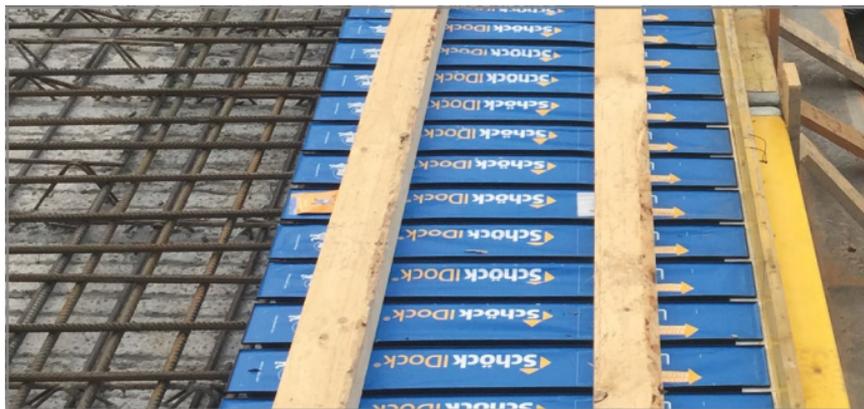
maintenir l'élément de dalle en place à l'aide de poutres ou de madriers d'échafaudage
